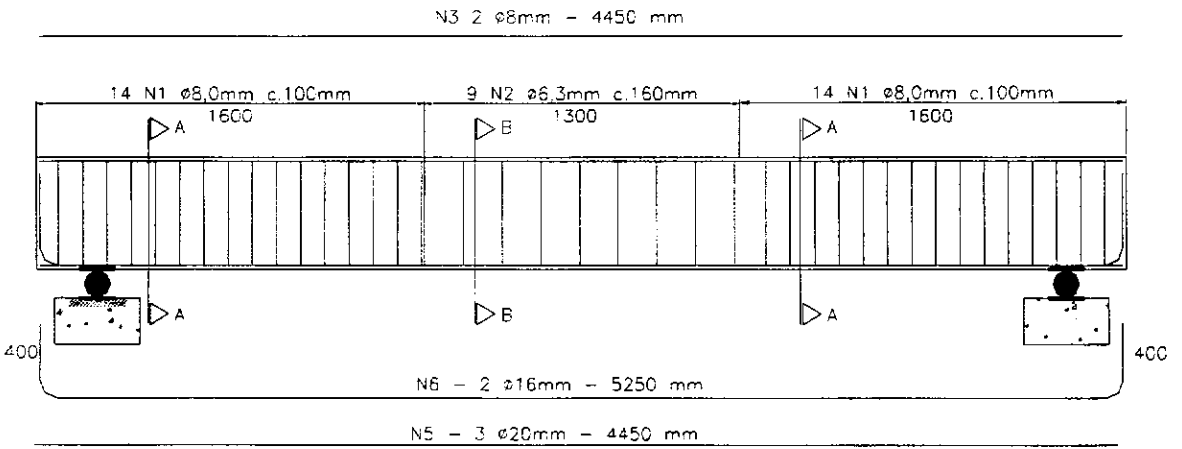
Detalhamento da armadura interna da viga VM-1R
